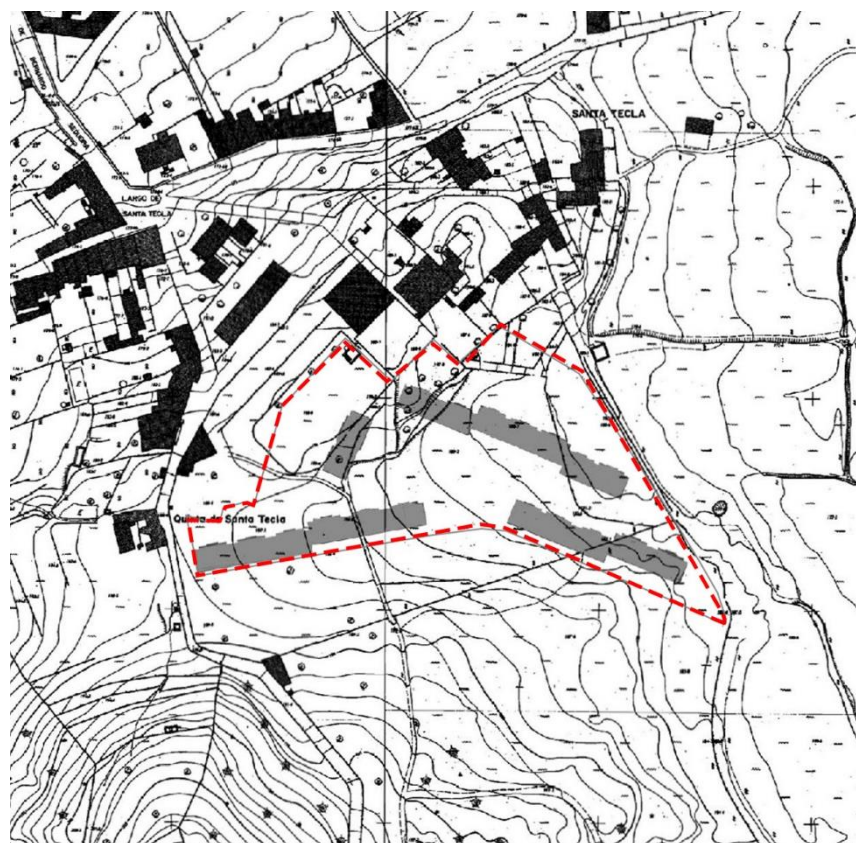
Planta do ano de 1968. Localização do Bairro Social de Santa Tecla.
